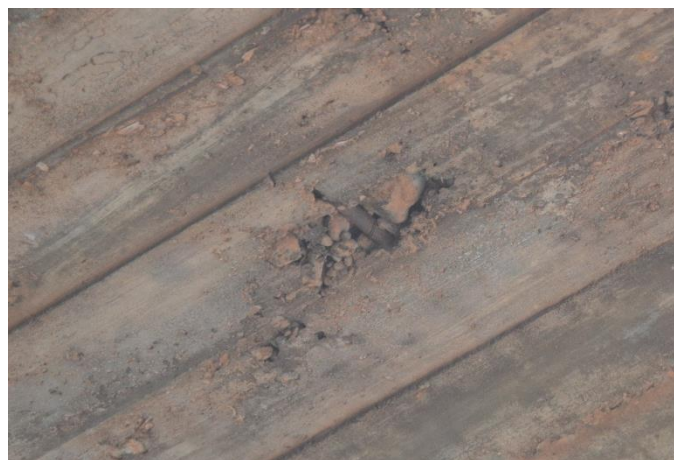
Falha de Concretagem no elemento Tabuleiro – Viaduto W –11/12 Norte.
